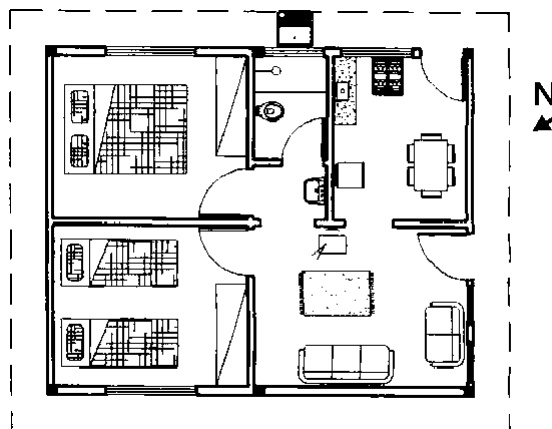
Planta original das casas (ALTO NÍVEL, 1999)
